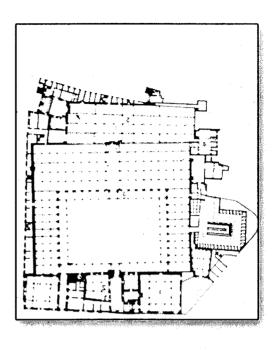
جامع الكوفة (مسقط أفقي) عن :فريد شافعي
